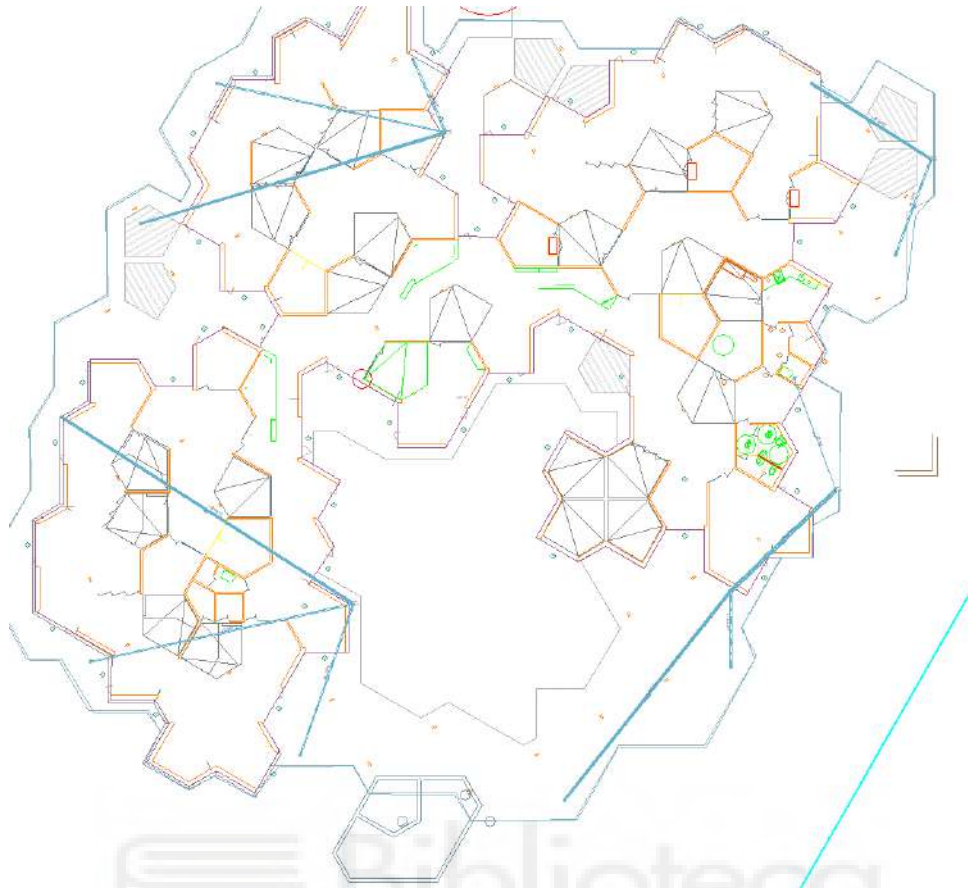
Vista planta - Saneamiento (Cubierta, pluviales)
